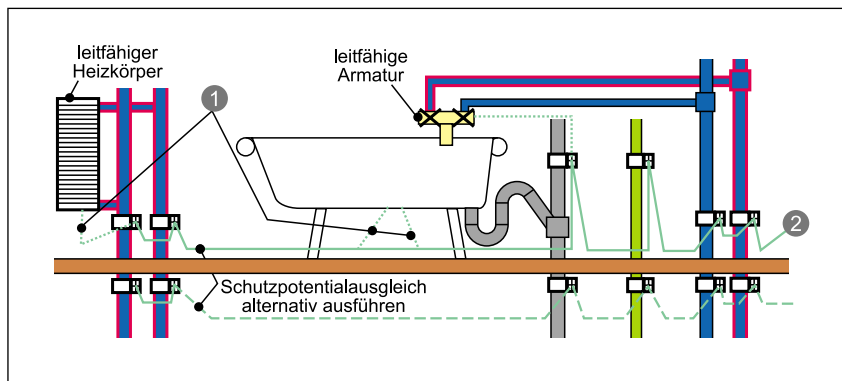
Detail zu Bild 1 – Schutzpotentialausgleich an leitfähigen Wannen nicht mehr gefordert, jedoch erlaubt:
